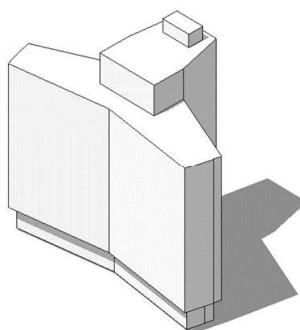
Planta elevada y *pilotis*, edificio Italia.
